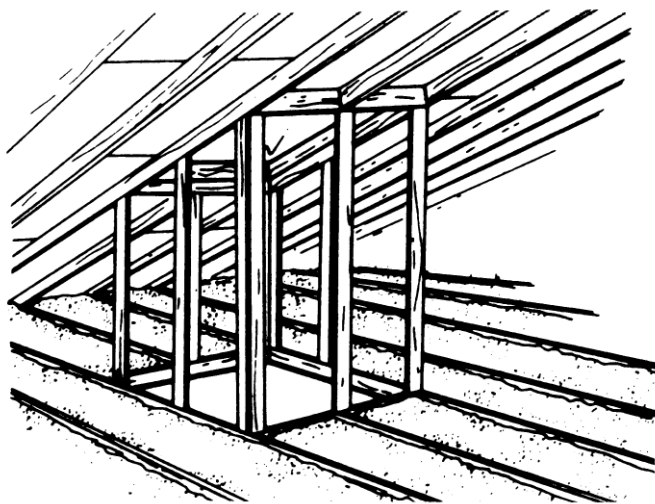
Изготовление рамной конструкции световой шахты (Novi)
